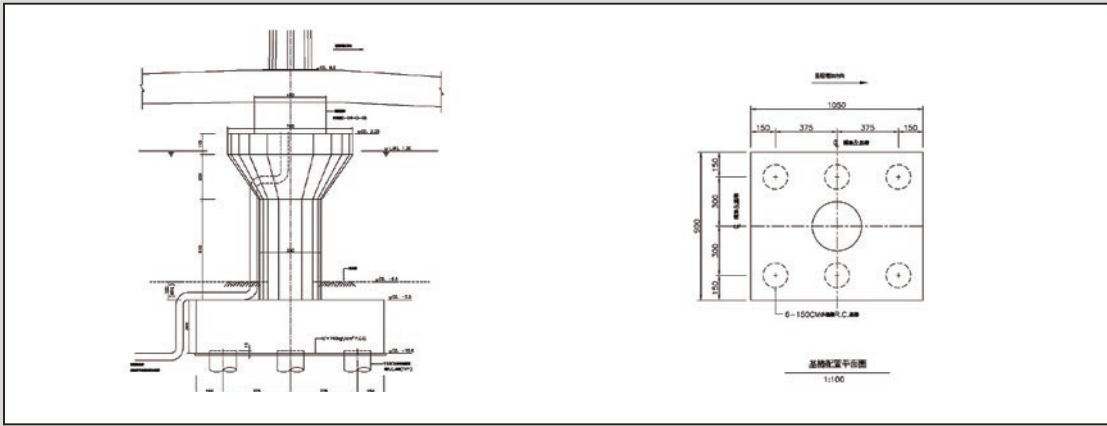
大港橋P2橋墩立面圖、基樁平面配置圖
